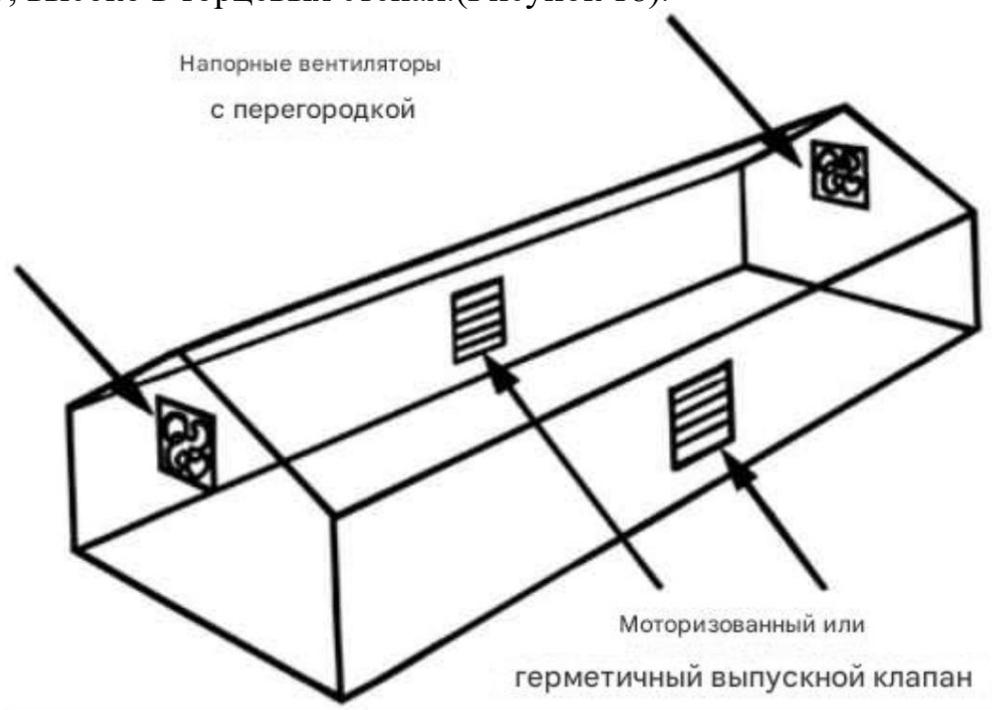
Нагнетательные вентиляторы, установленные высоко в торцевых стенах.
